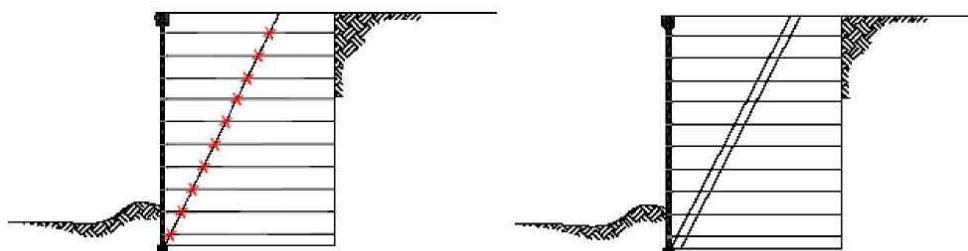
Rotura por tracción y por arrancamiento en los refuerzos
